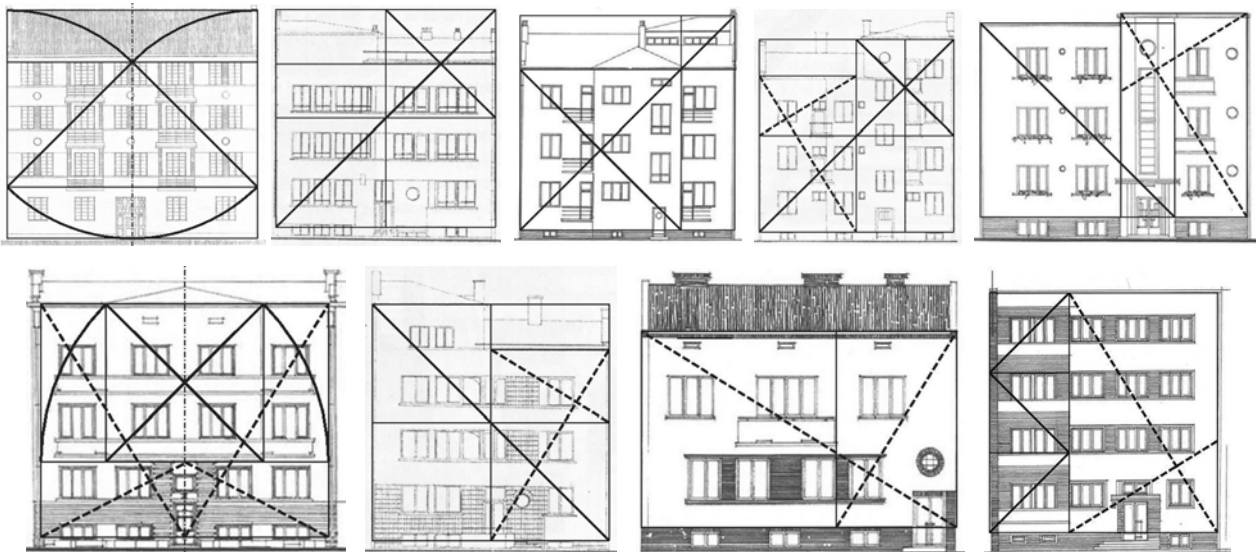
Схеми пропорціювання фасадів у стилі функціоналізму
